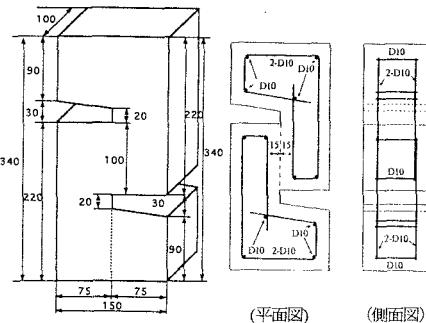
供試体形状ならびに補強鉄筋配置(単位はmm)
